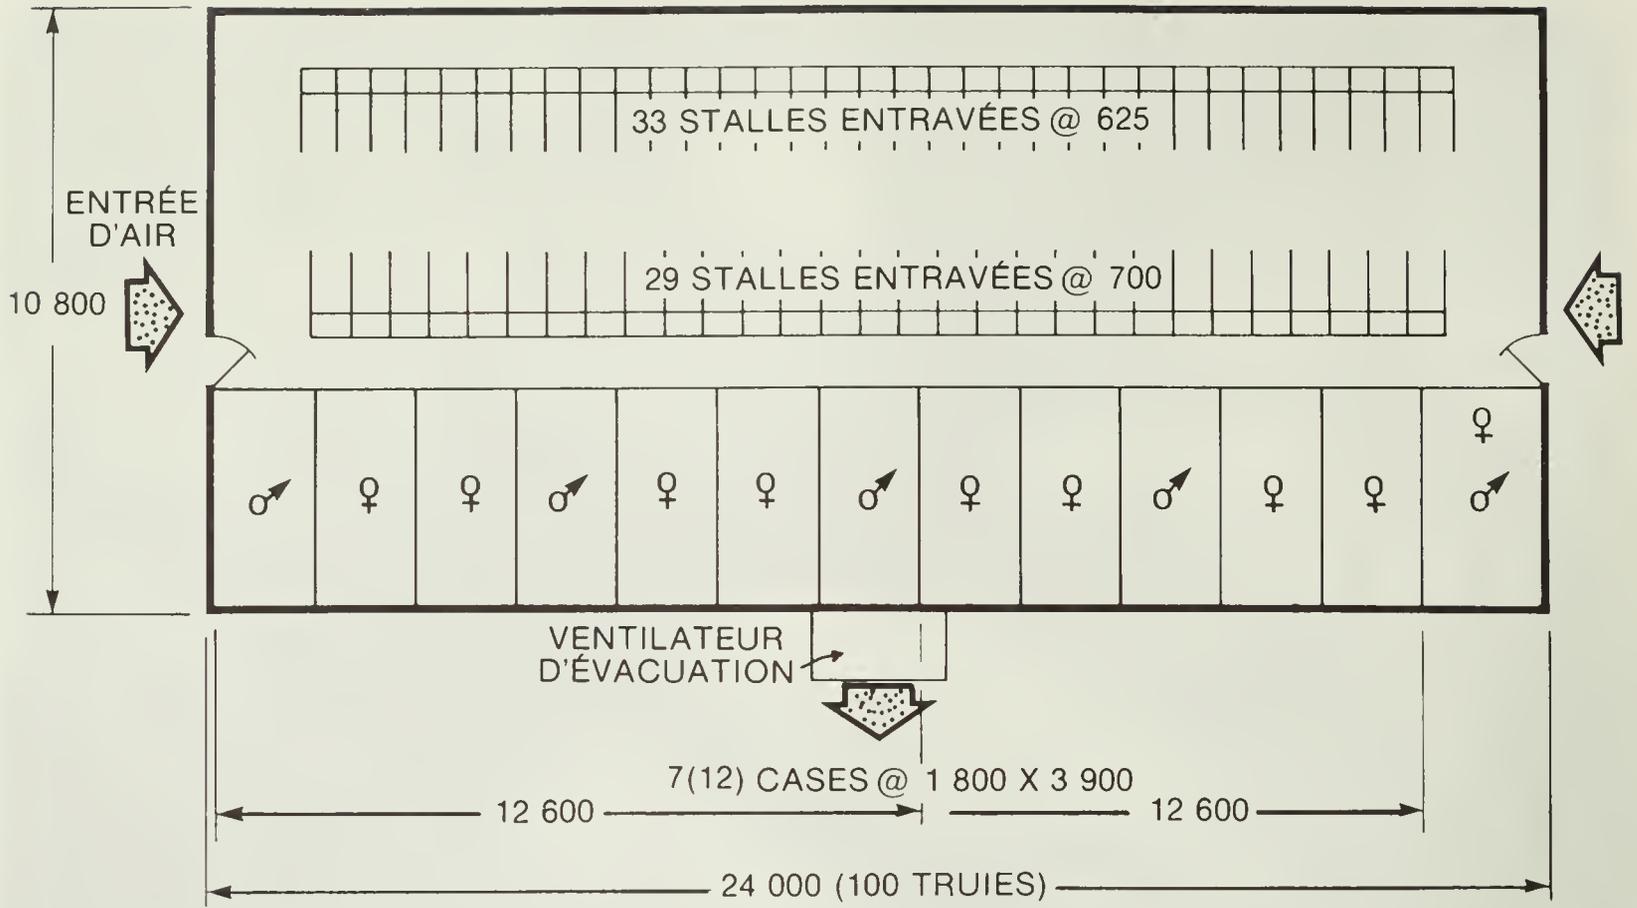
Plan d'une section d'accouplement et de gestation avec stalles à entraves pour truies en gestation, et cases pour jeunes truies ou verrats de reproduction
